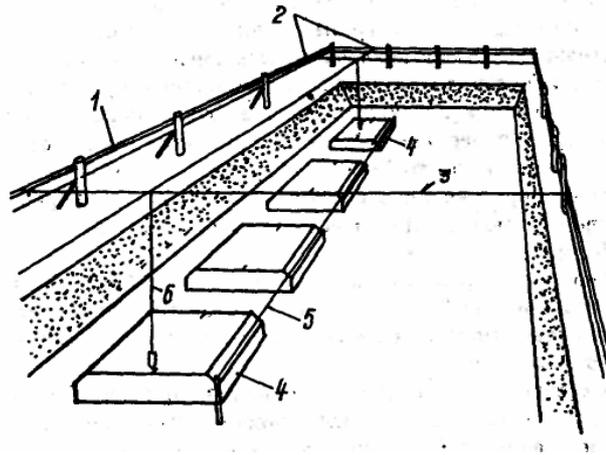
Схема перенесения разбивочных осей в котлован отвесами:
